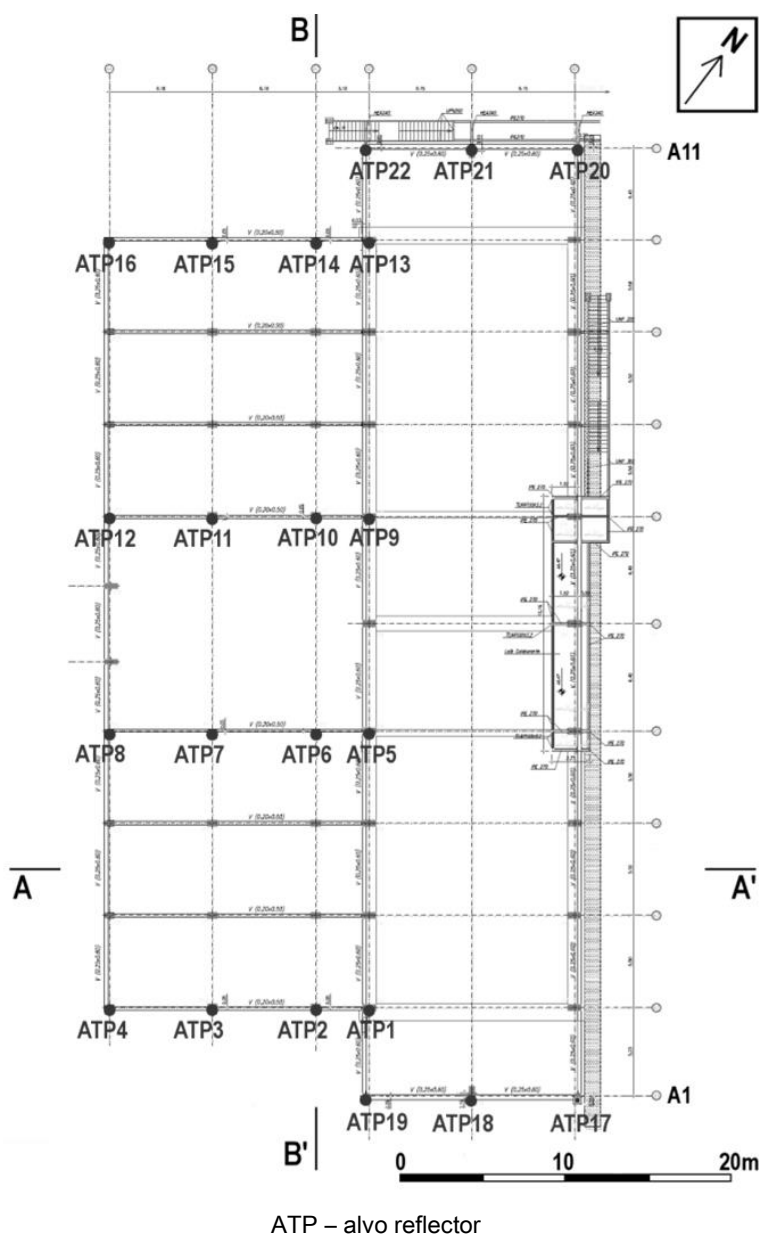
Planta à cota 4,0m com localização dos dispositivos de observação na Zona 1
